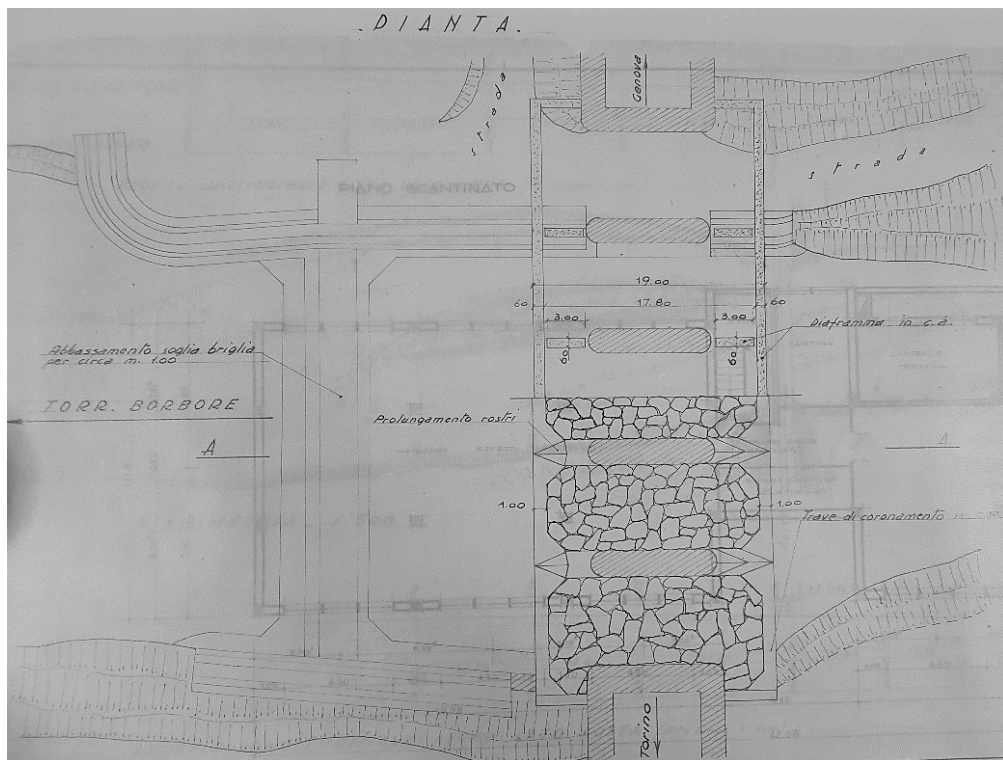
Pianta dell'opera, elaborato 4676/273
